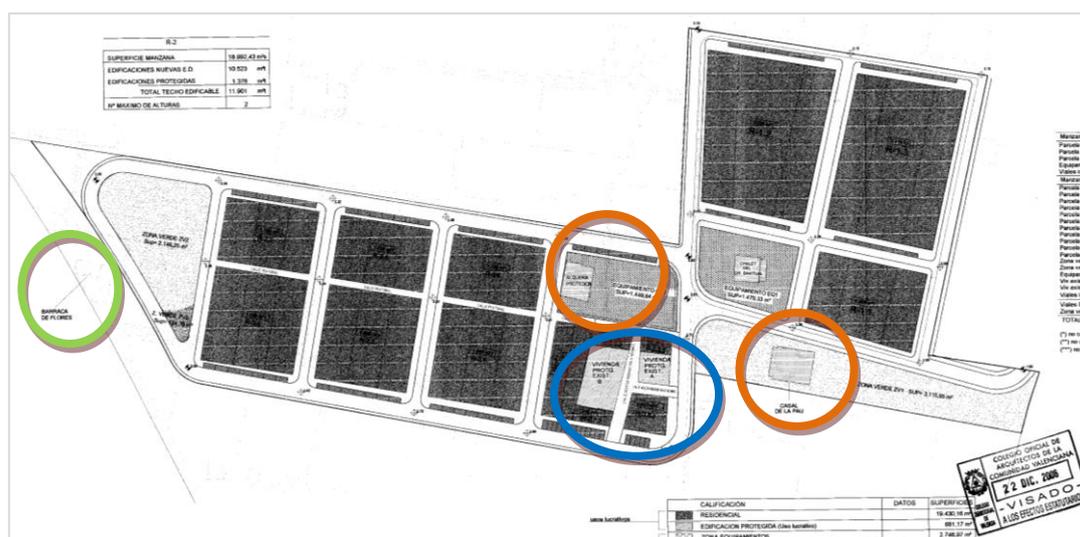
Edificaciones Protegidas en la Zona de Viviendas
